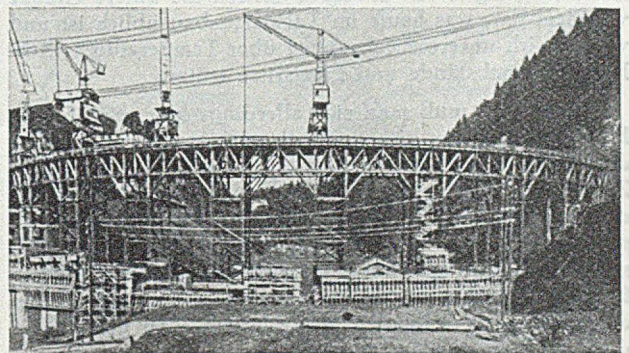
Rossens-Staumauer (Schweiz). Betonierbrücke mit Einbringekranen.
